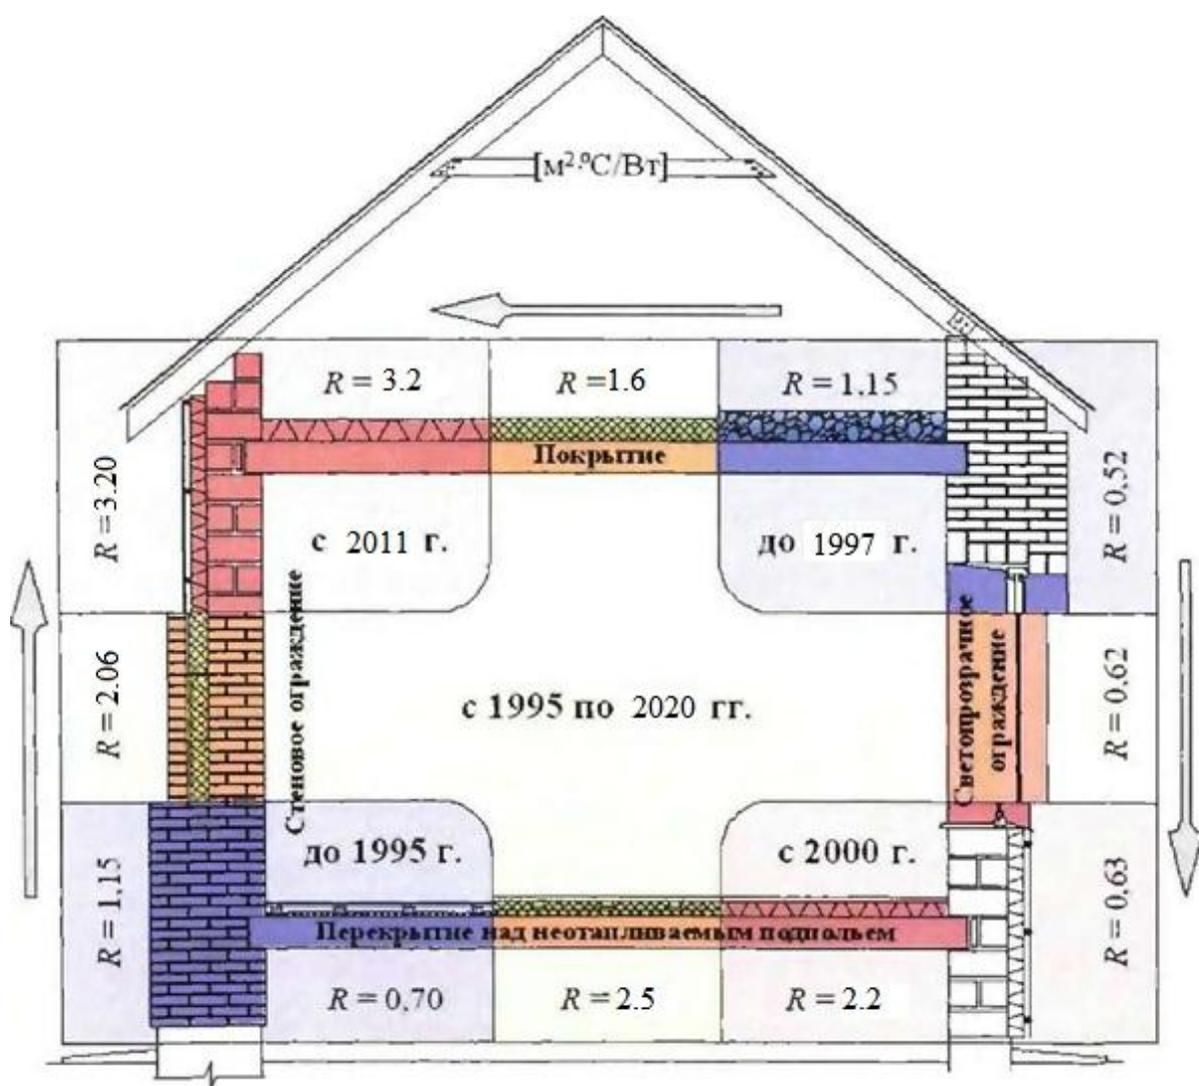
Поэтапное повышение нормируемых значений сопротивления теплопередаче типовых ограждающих конструкций жилого здания
